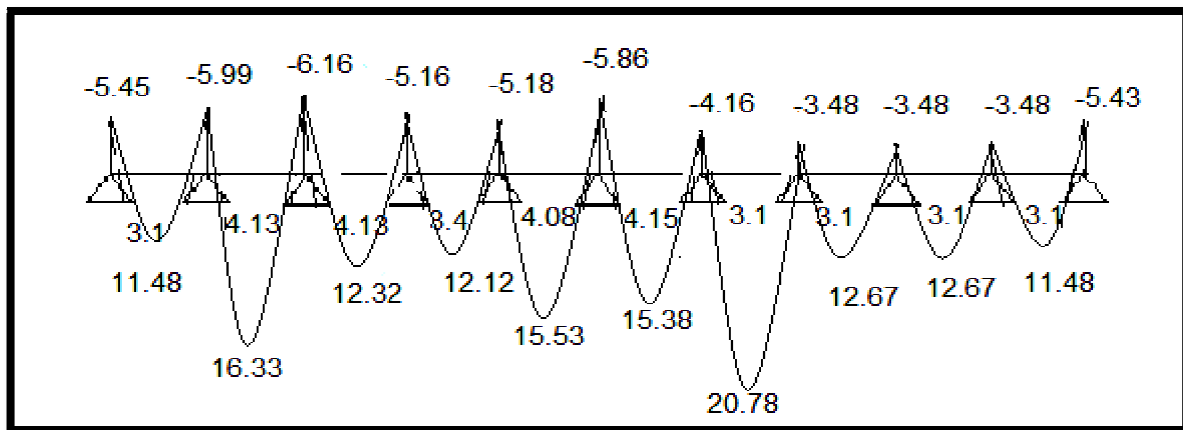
Diagramme des moments à l'ELS des poutrelles du plancher Plancher terrasse (type 1)
